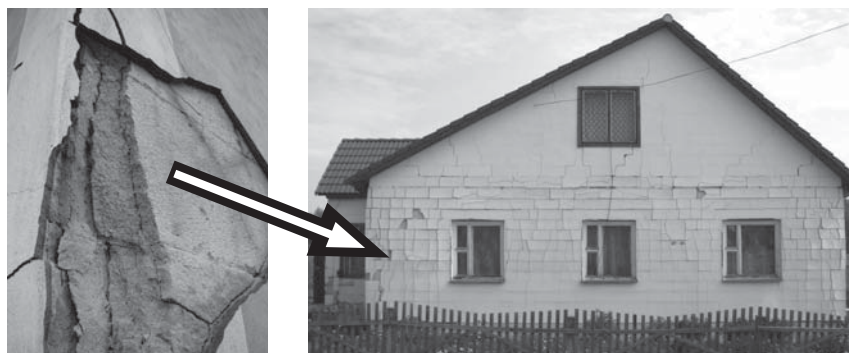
Деструкция материалов наружных стен жилого дома вследствие размораживания наружных слоев кладки из ячеистобетонных блоков с высокой влажностью
